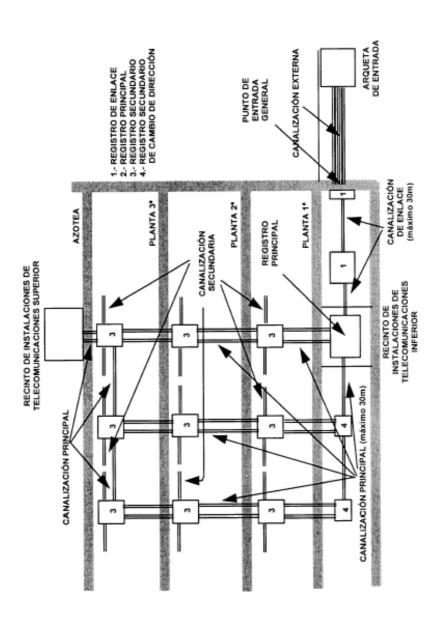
Croquis de conducciones desde el exterior de la vivienda.
